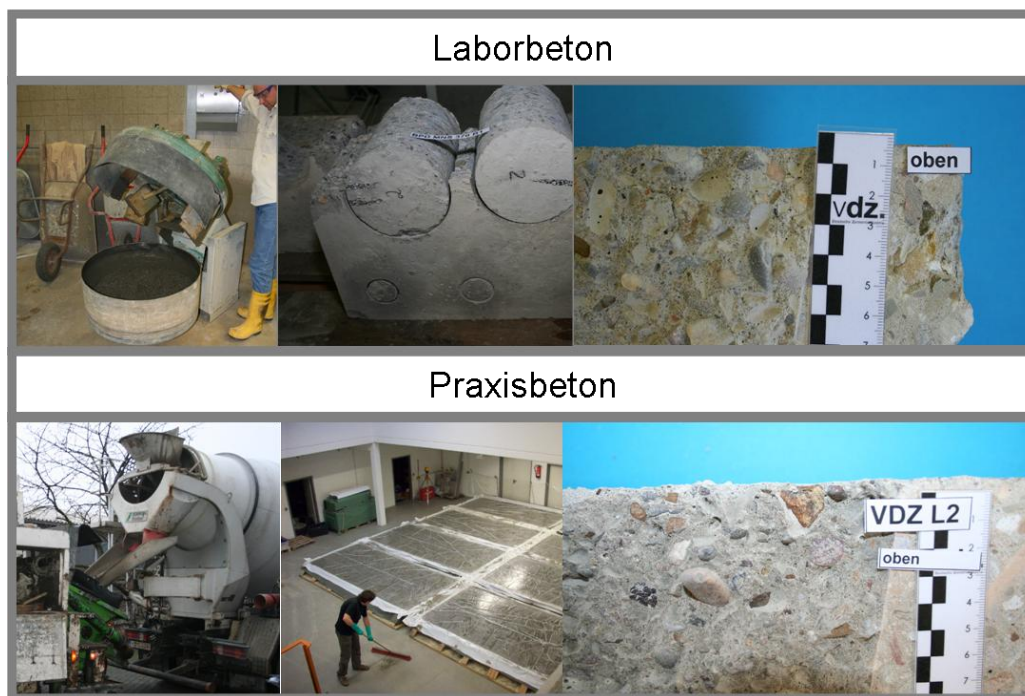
Laborbeton und Praxisbeton: Betonherstellung, horizontale Fläche und erhärteter Betonschnitt
